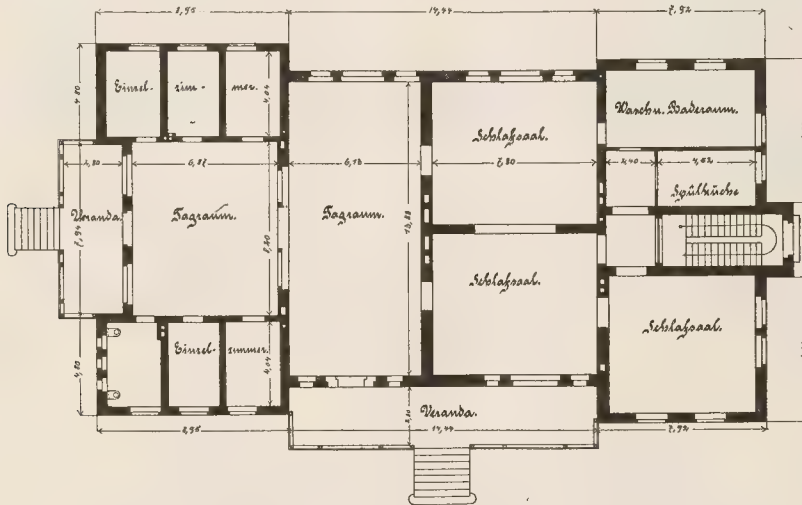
Gebäude 3 und 4. Grundriss.
